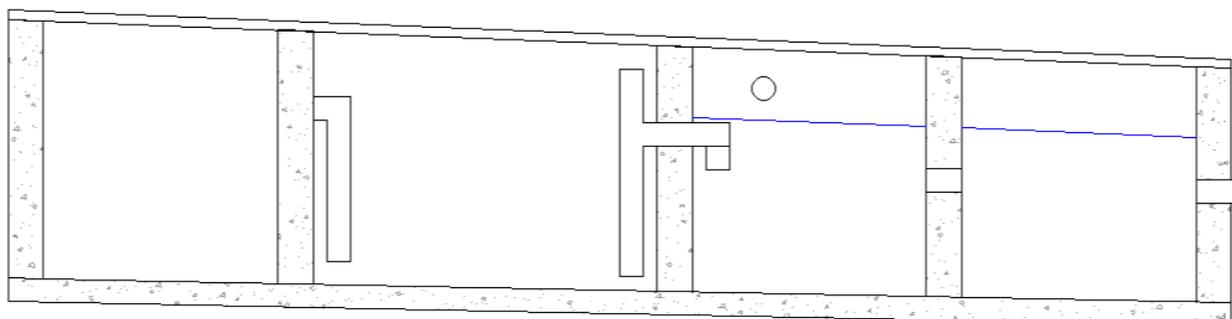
Trampa de grasas Italcol planta 2 vista perfil
